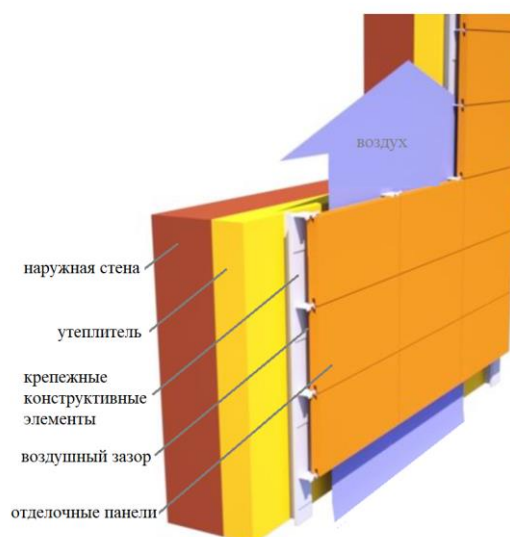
Конструкция наружной стены с вентилируемой фасадной системой
